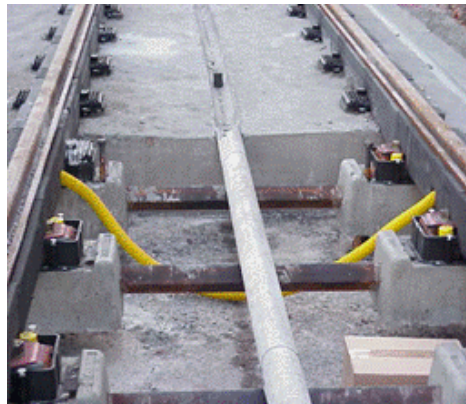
Photo de connexion aux rails d'un circuit de voie tramway
